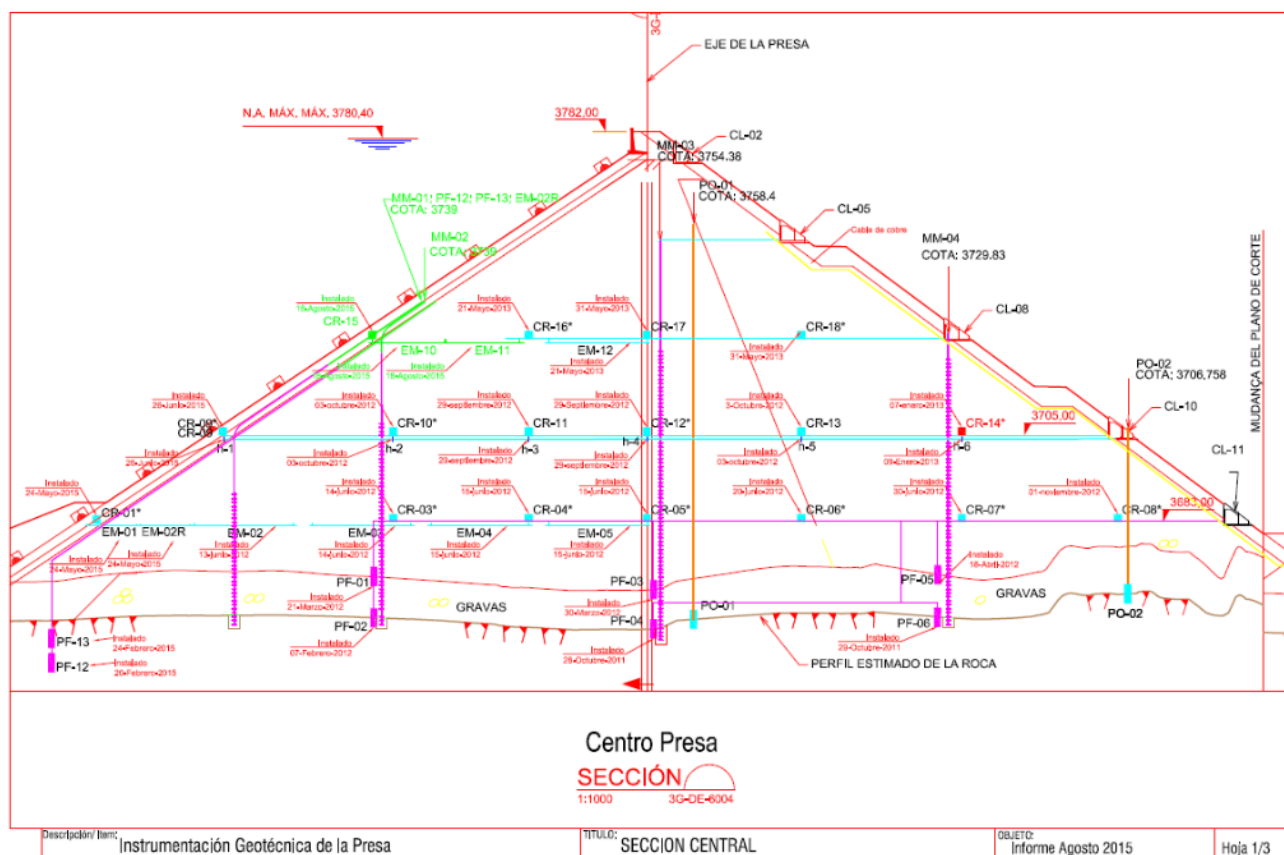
Sección central de la presa con el detalle de los instrumentos instalados.
